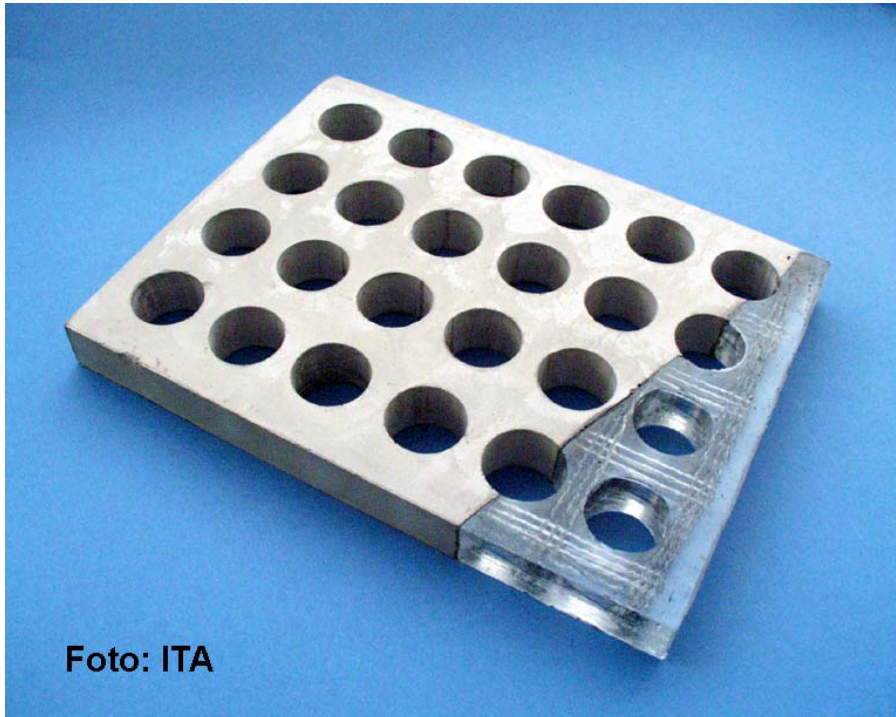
ITA: Fassadenplatte aus textilbewehrtem Beton
